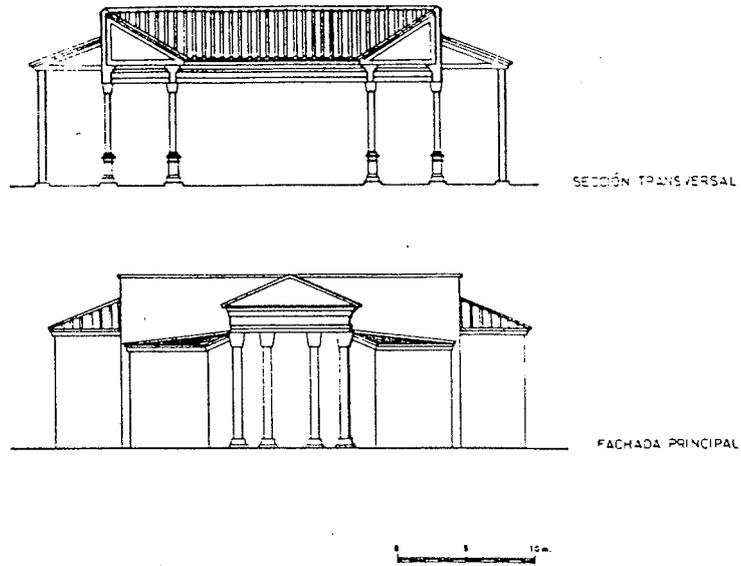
Fachada y corte transversal restituidos del edificio flavio, (Arq. A. Rodríguez Calero).
